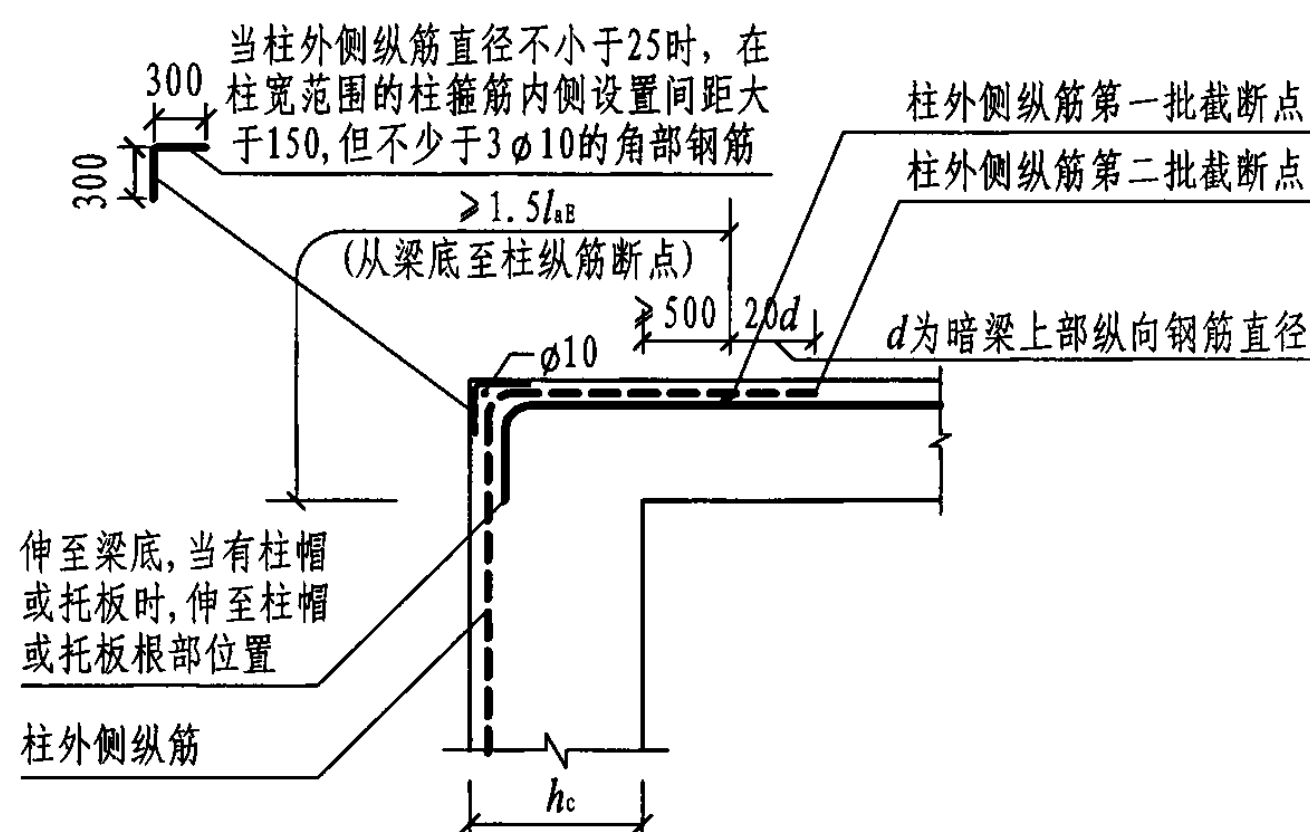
抗震板柱结构屋面框架暗梁纵向钢筋构造
